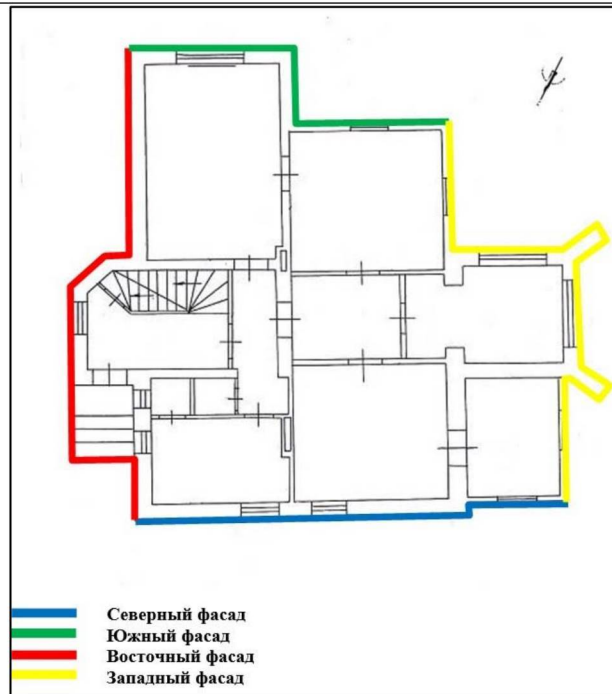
План первого этажа. Схема расположения фасадов Памятника
